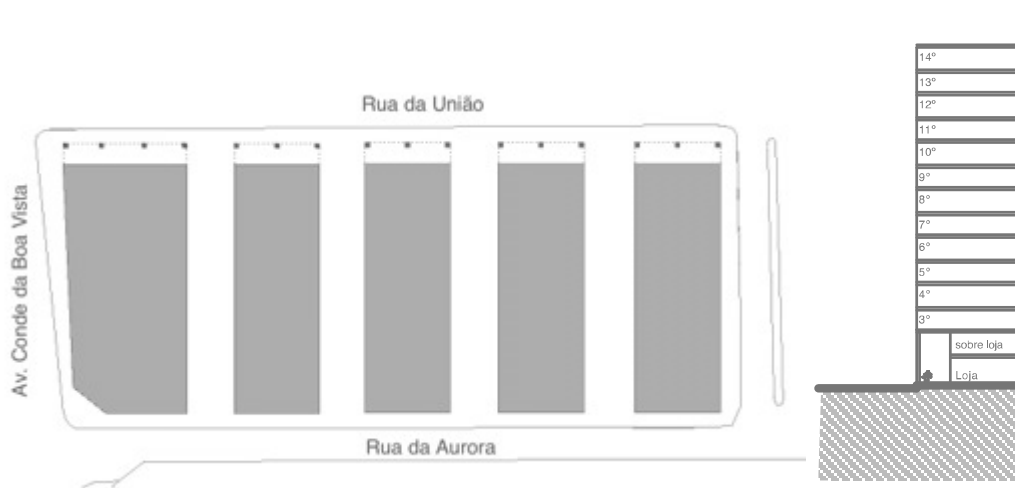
La galería cubierta que unía la avenida Conde da Boa Vista a la calle Princesa Isabel fue prevista por la ordenanza de 1919. Los arquitectos modernos la incorporan para los proyectos de los bloques para las manzanas de Boa Vista.
